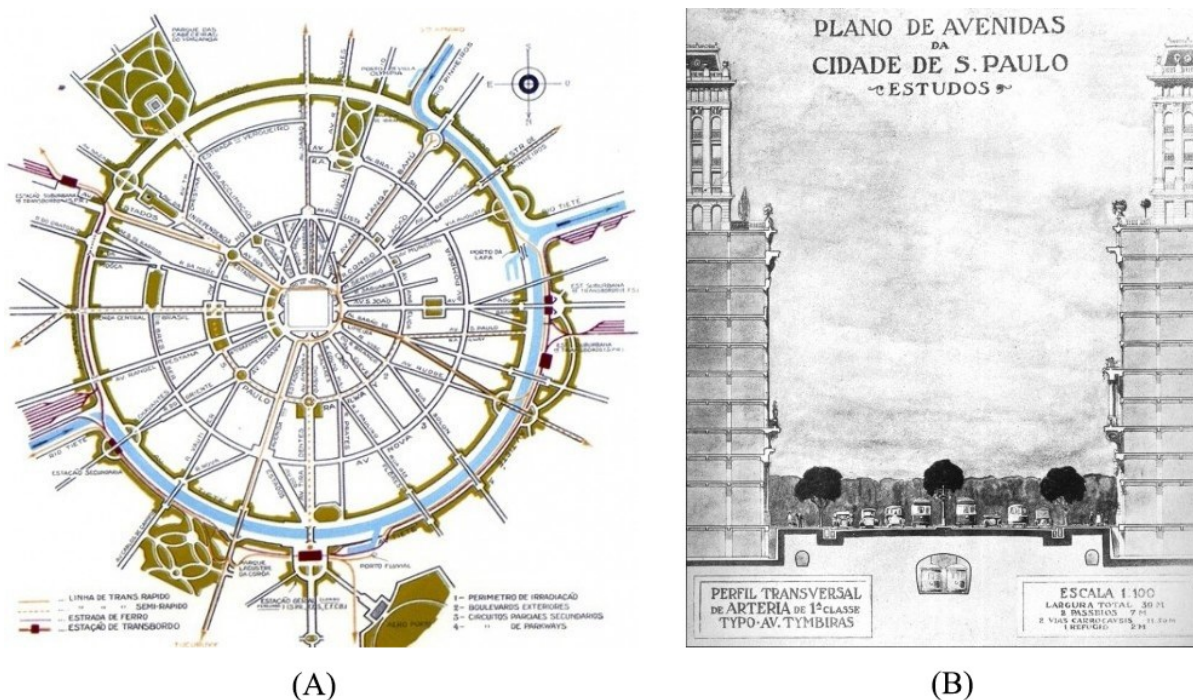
(A) Esquema do Plano de Avenida de Prestes Maia. (B) Corte esquemático da via e edificações do Plano de Avenidas.
